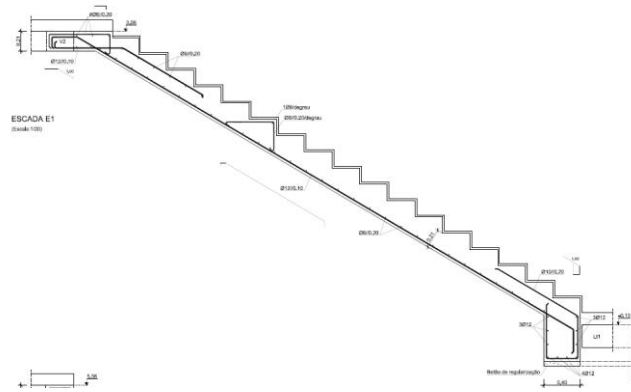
Pormenor das escadas do R/C para o 1º piso [17]
